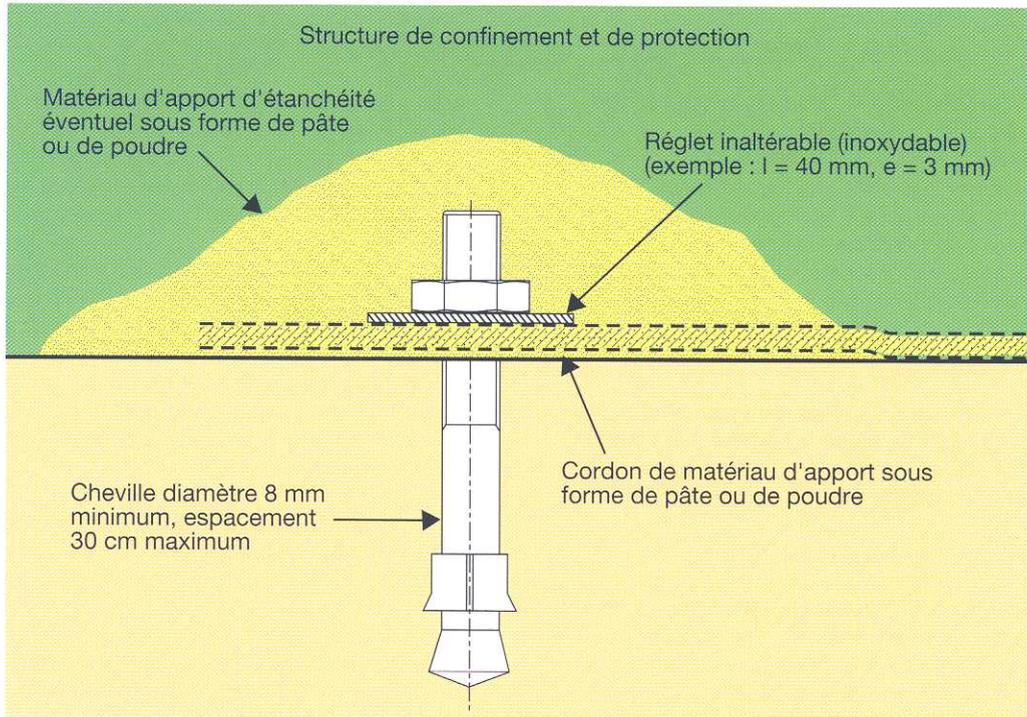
Exemple de raccordement étanche sur un ouvrage annexe
